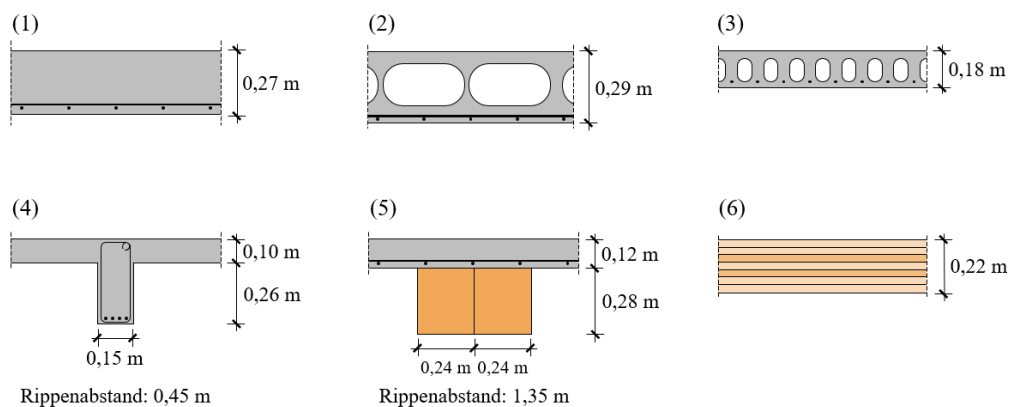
Betrachtete Deckenquerschnitte: (1) Stahlbetonmassivdecke, (2) Hohlkörperdecke, (3) Spannbetonhohldiele, (4) Stahlbeton-Rippendecke, (5) Holz-Beton-Verbund-Rippendecke, (6) Brettsperrholzdecke
